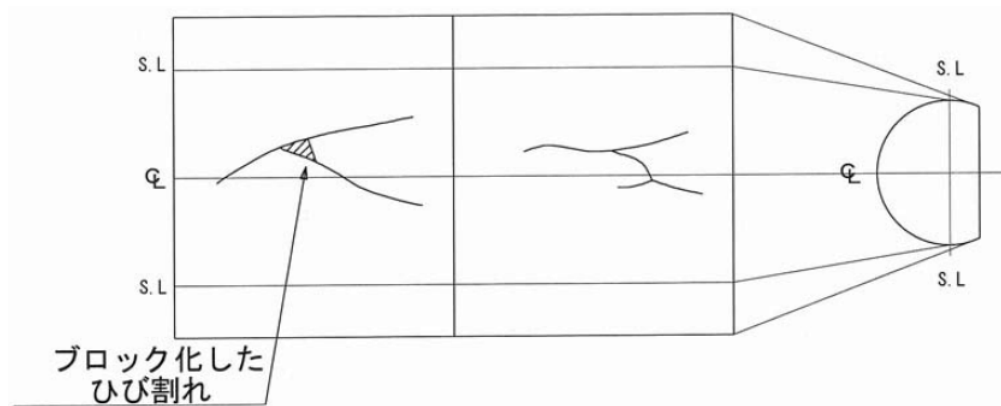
6 複数のひび割れでブロック化した覆工コンクリートの例
